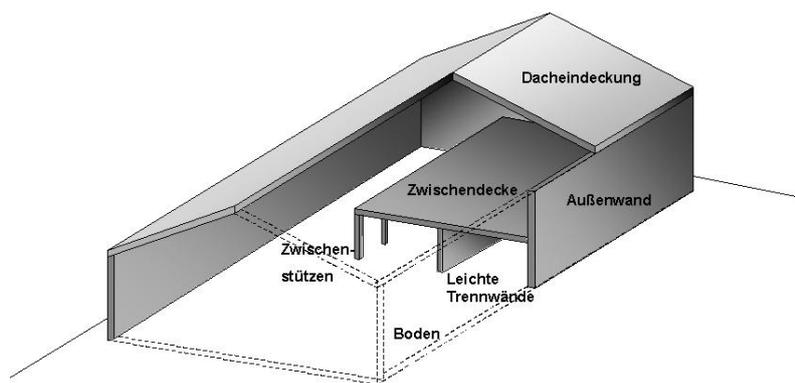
Funktionale Komponenten raumabschließender Bauelemente
